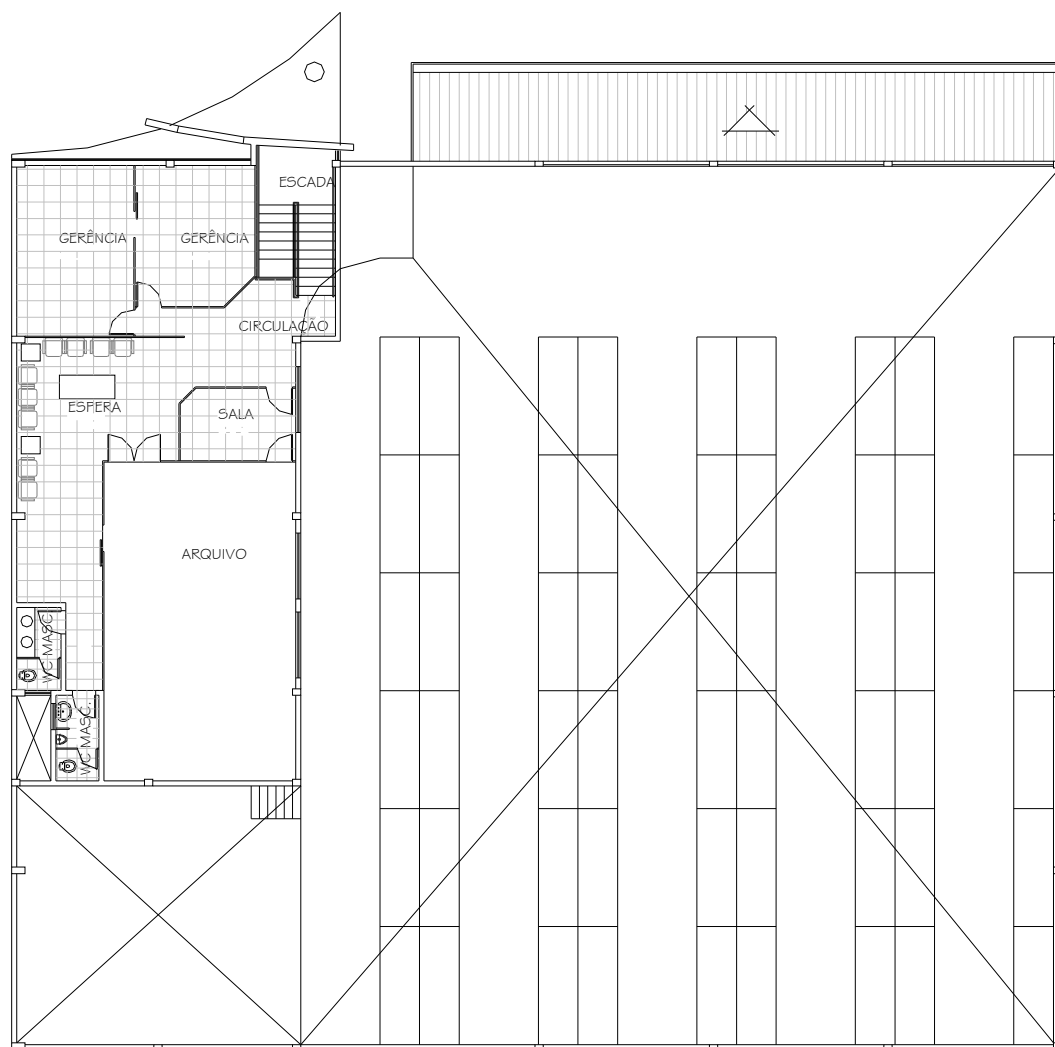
Cooper Itaipu - pavimento tipo (x2)
